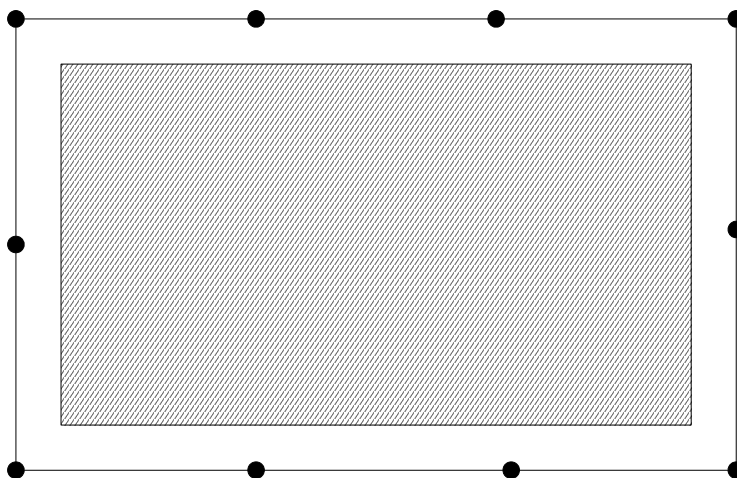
Розташування контуру заземлювального пристрою
